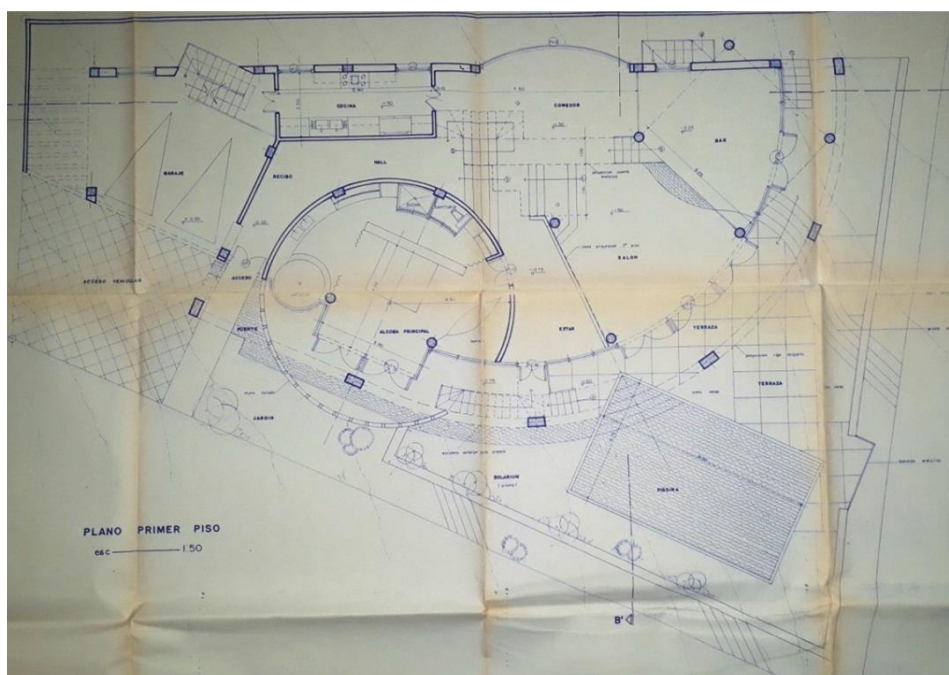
planta arquitectónica vivienda 1 piso (1993).
